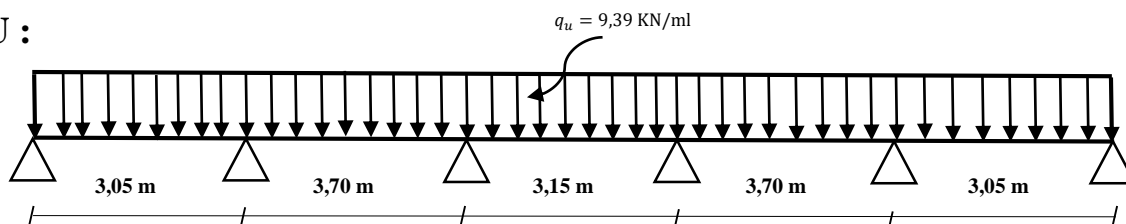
Schéma statique de la Poutrelle à (5 Travées) à l'ELU
